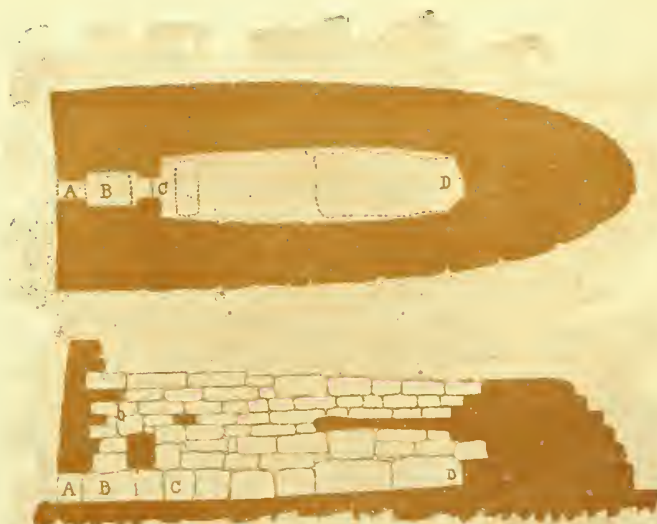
PLANTA Y CORTE DE LA NAVETA D'ES TUDONS
